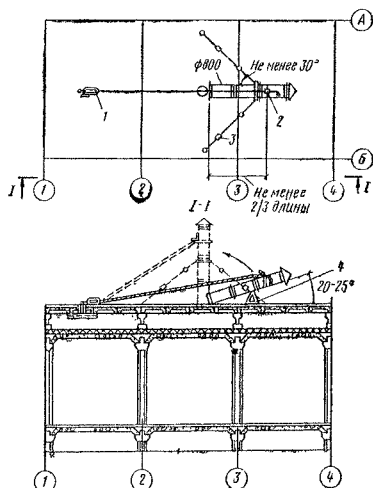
Монтаж вентиляционной шахты с помощью лебедки
